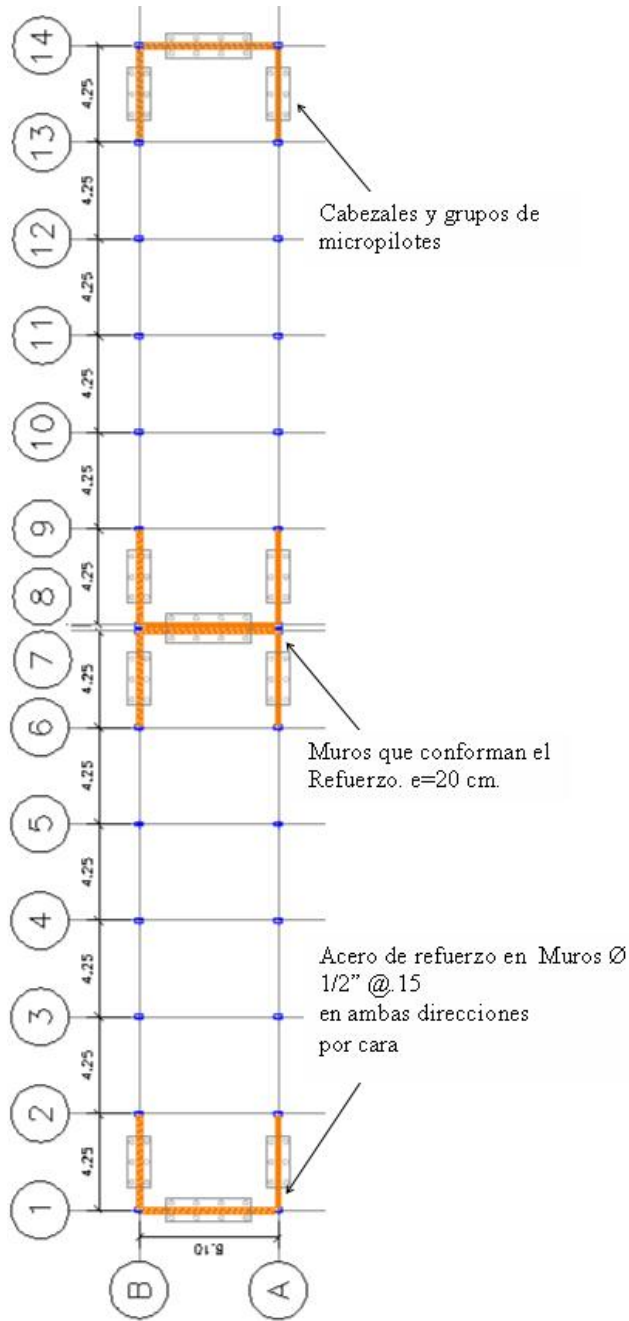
Planta Nivel +0.00. Propuesta de Fundación
